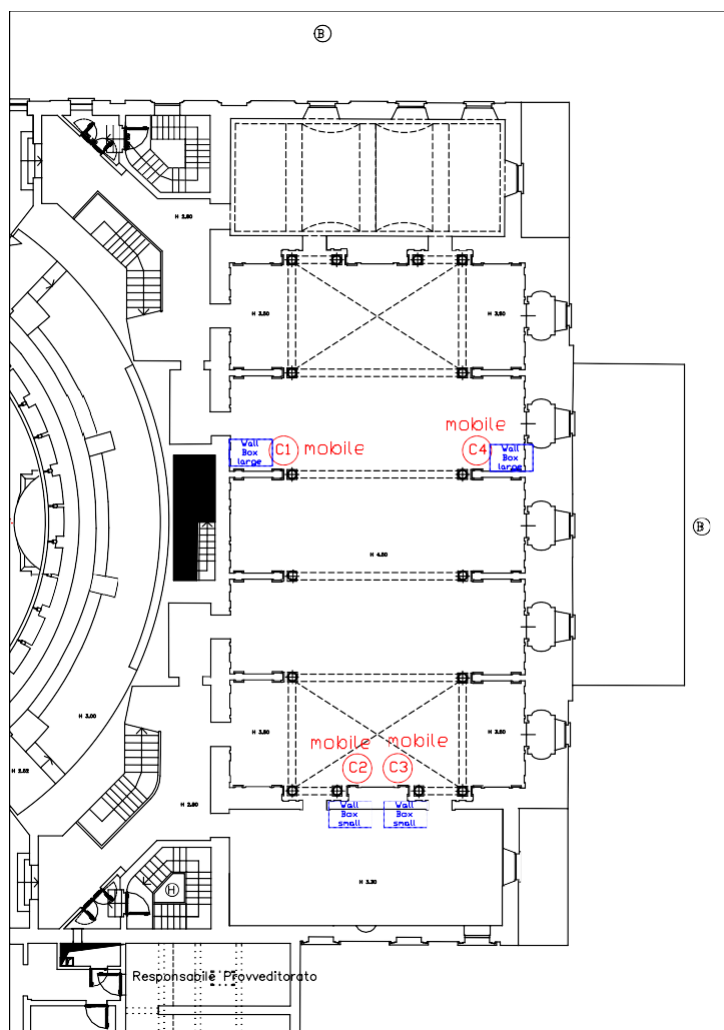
vista schematica anteriore delle ubicazioni proposte per telecamere e hub di segnale (Wall Boxes) nel Ridotto Galleria.
